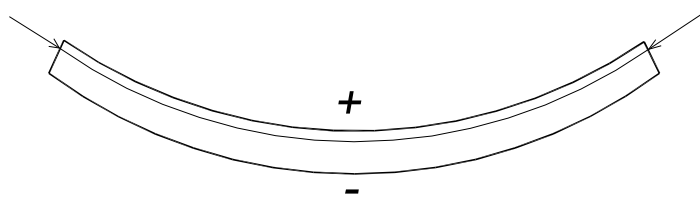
Efecto del Momento en la Losa de Cimentación en la Condición Center Lift
